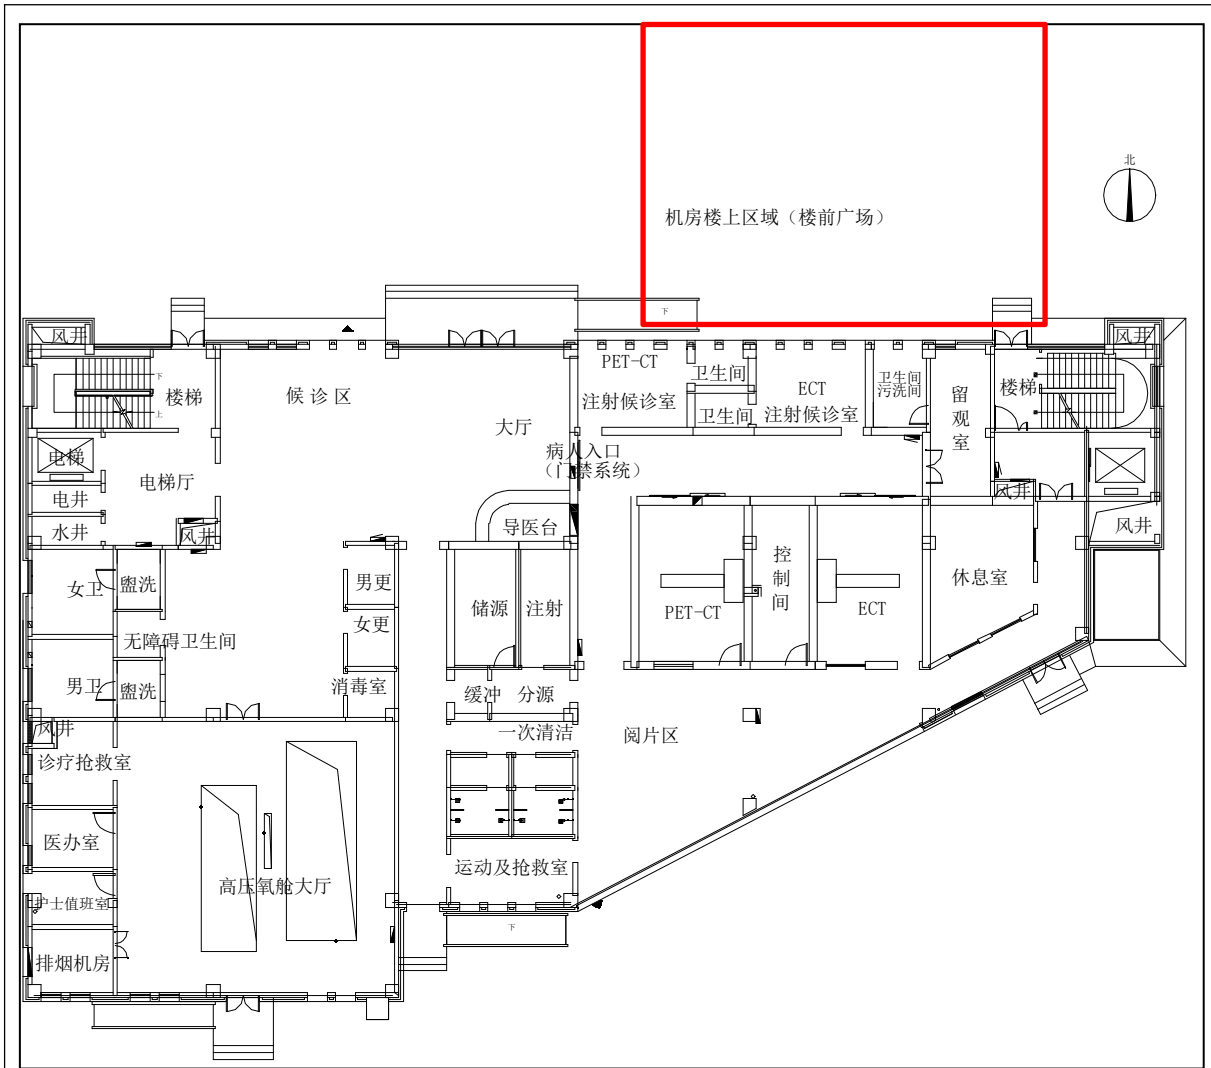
肿瘤治疗中心楼一层平面图（红框内为本项目机房楼上区域）
